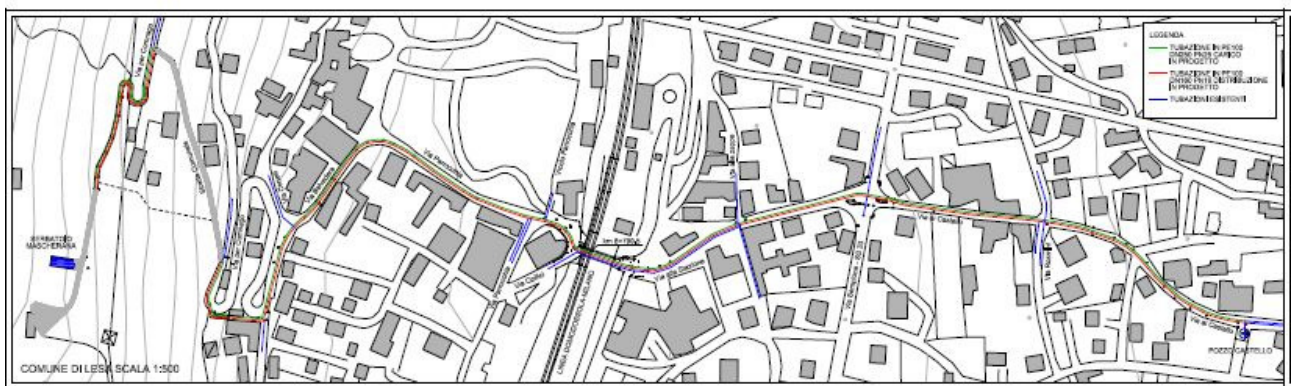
PLANIMETRIA DEL PROGETTO FORNITA DAL COMMITTENTE
